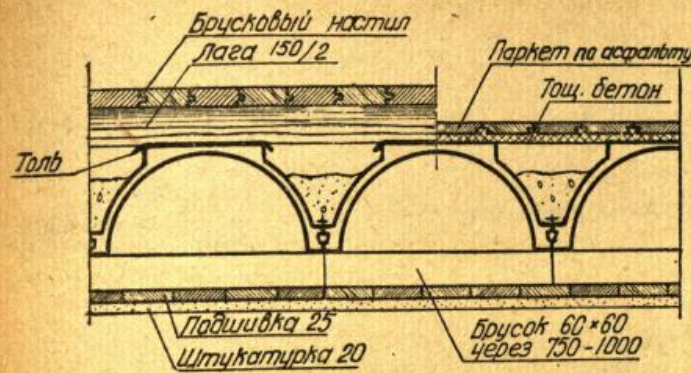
Сборное железобетонное перекрытие из сегментных элементов.
